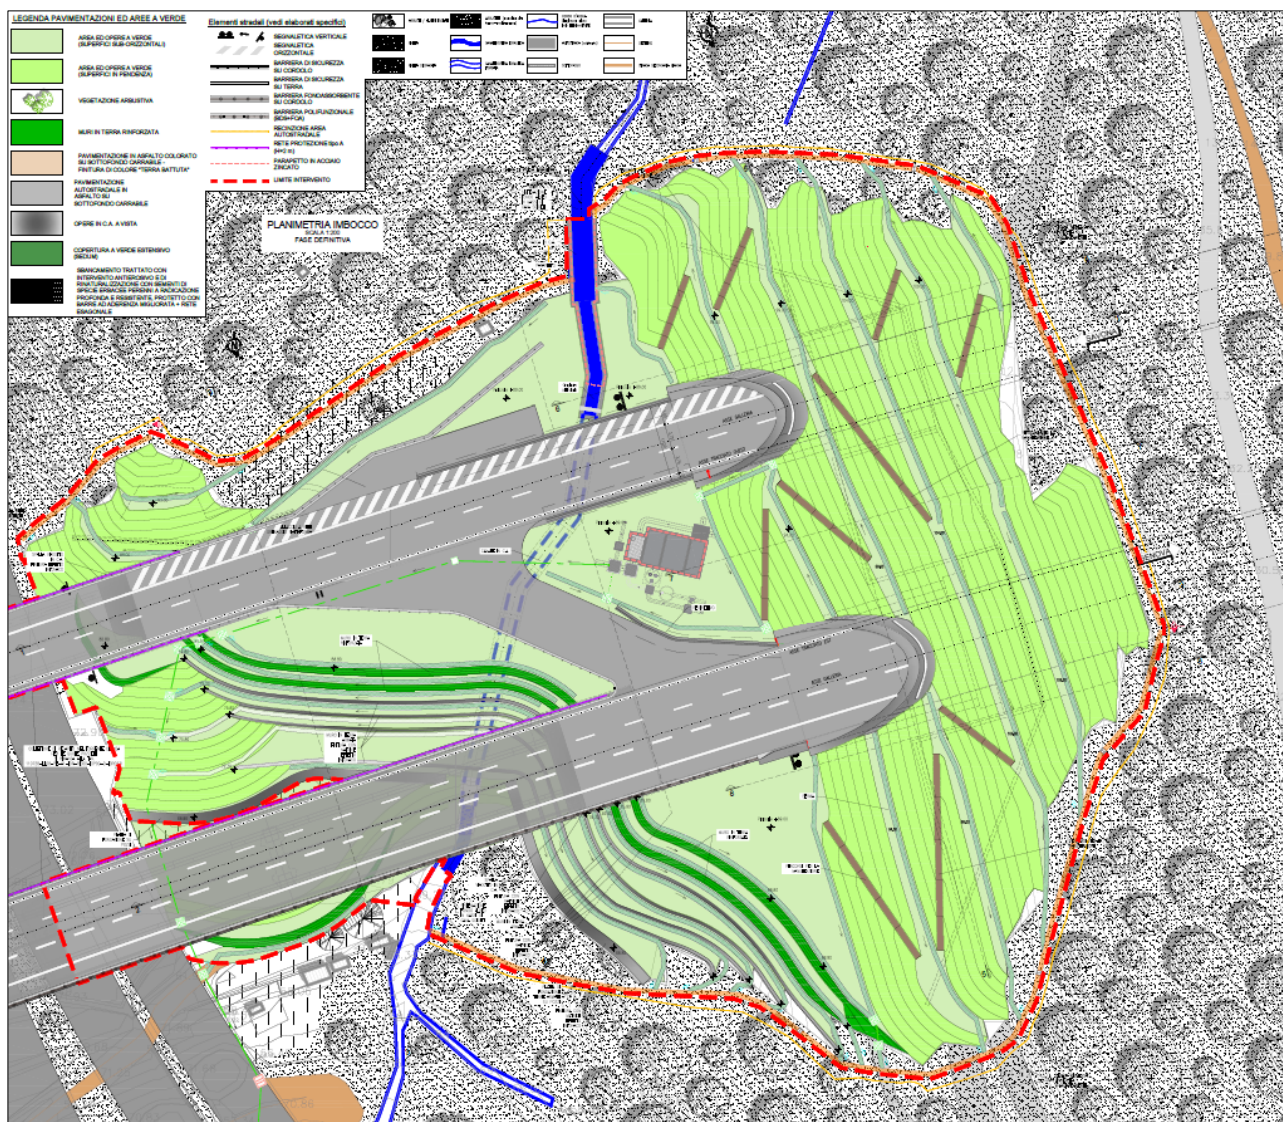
Planimetria stato finale dell'area di imbocco (fonte: elaborato 110728-LL8C-PE-A1-G03-GF03W-SSF00-D-AUA1476-1)
